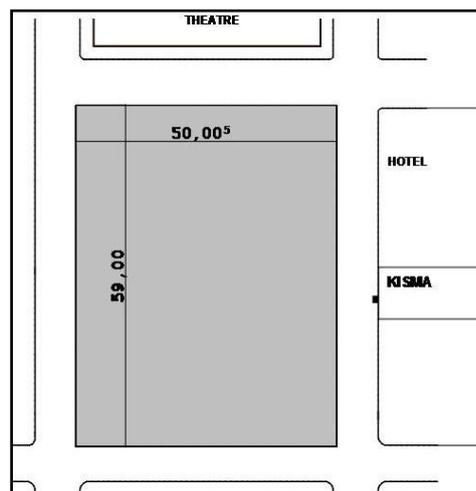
Rapport entre la longueur et la largeur du plan, de la place du théâtre, Source : Auteur 2011.
